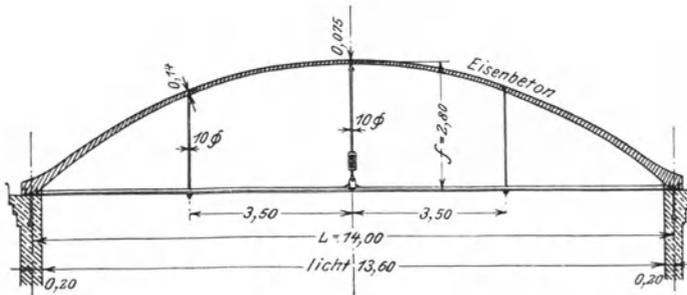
Tonnendach aus Eisenbeton mit Zugband.
